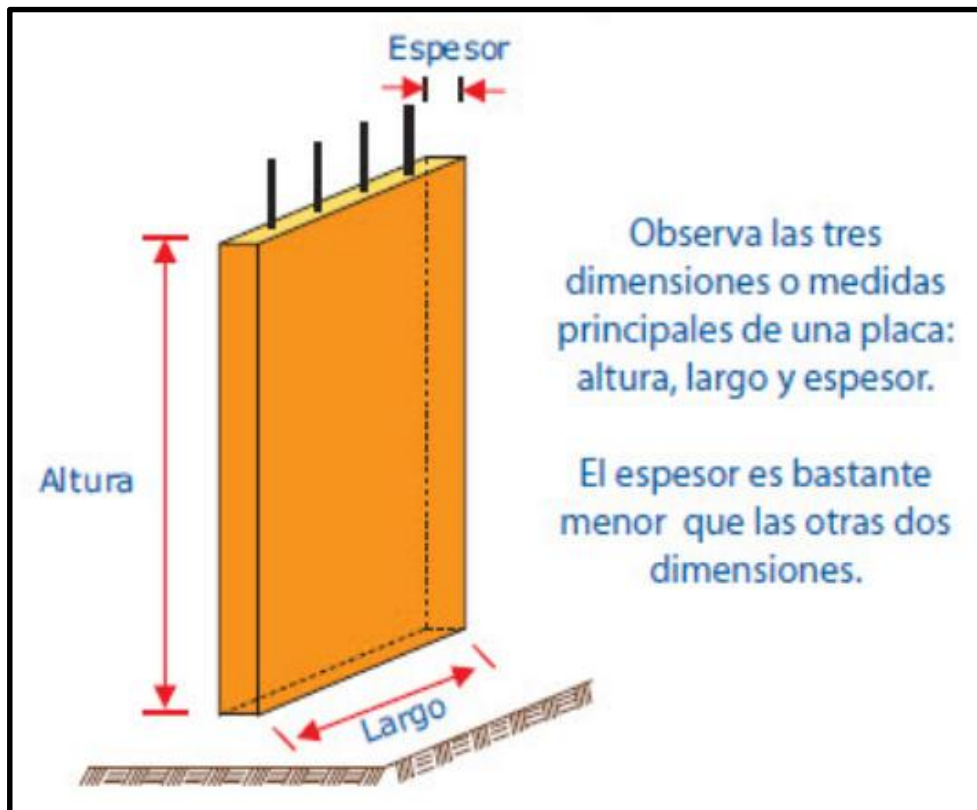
Dimensiones de una placa de concreto armado. Fuente: Aceros Arequipa.
